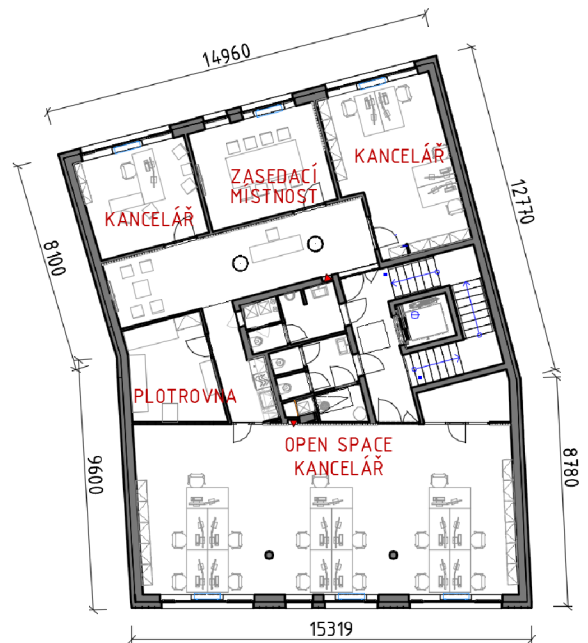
Půdorys 1.NP a 2.NP [upraveno dle 32]
